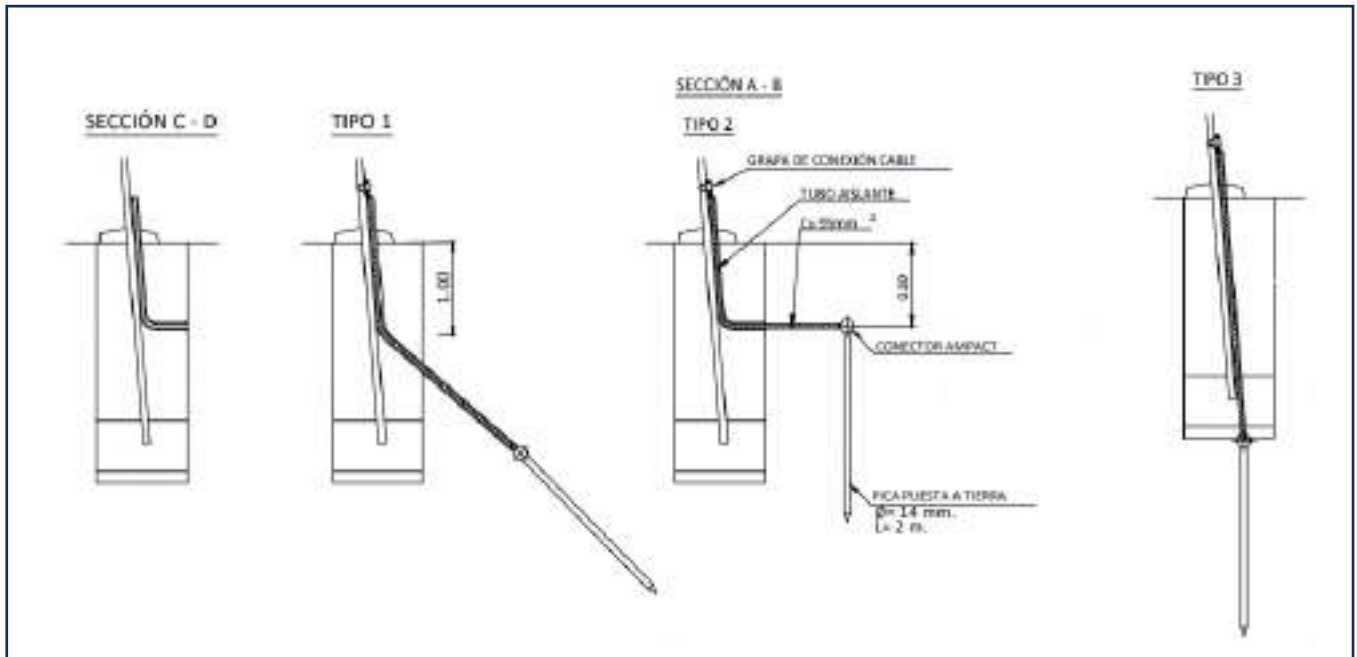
Plano explicativo puesta a tierra con grapas de conexión.
